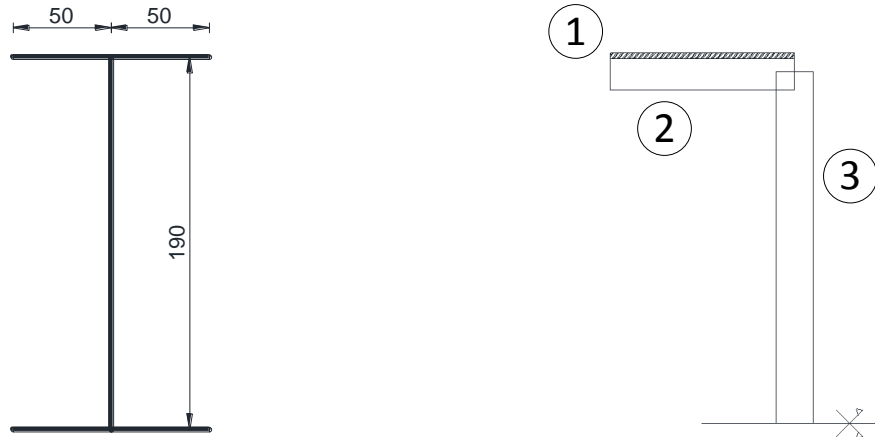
Esquematização da secção simplificada (medidas em mm)
